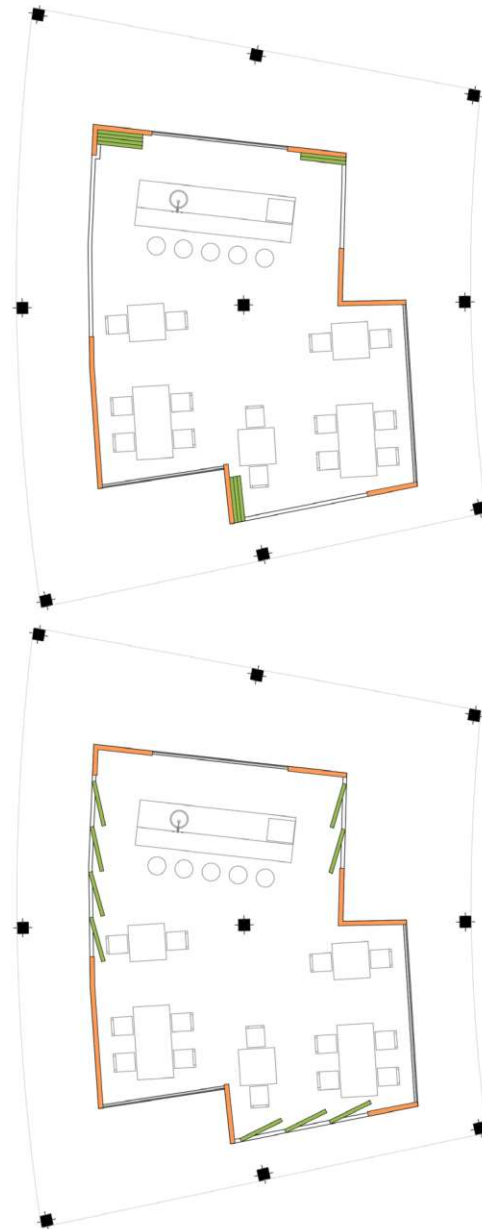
| Offenes und geschlossenes Hallenprinzip
